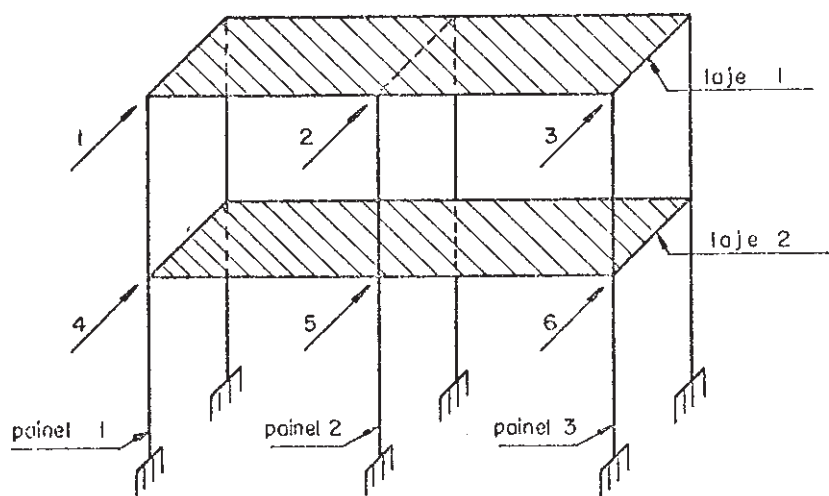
Estrutura numeração dos painéis, lajes e deslocamentos.
